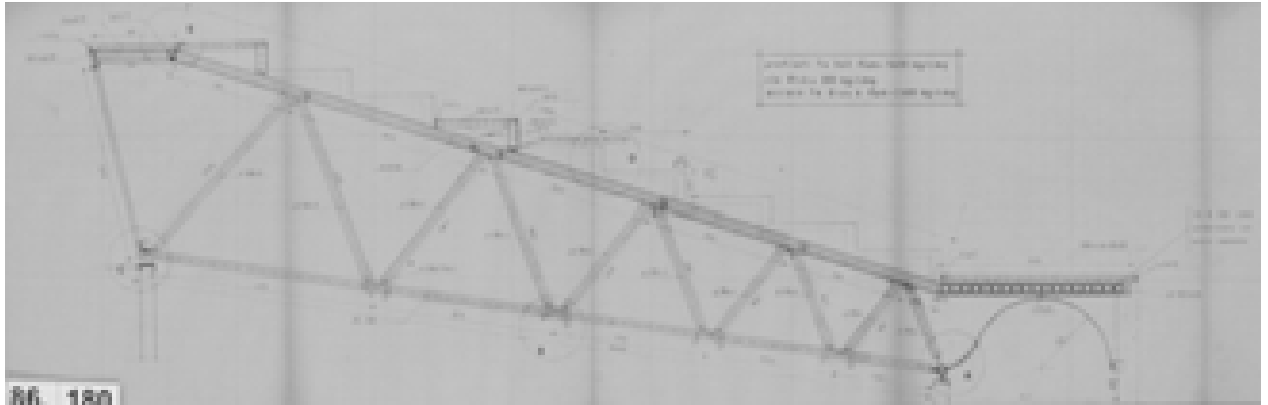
Variante al progetto esecutivo della trave reticolare, 1987 (AABS-180)
